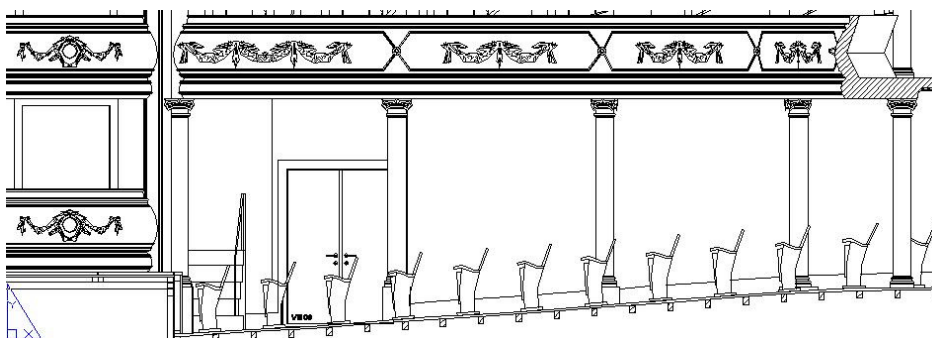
Corte que demonstra o desnível do pavimento entre a entrada na plateia e a zona do palco.
